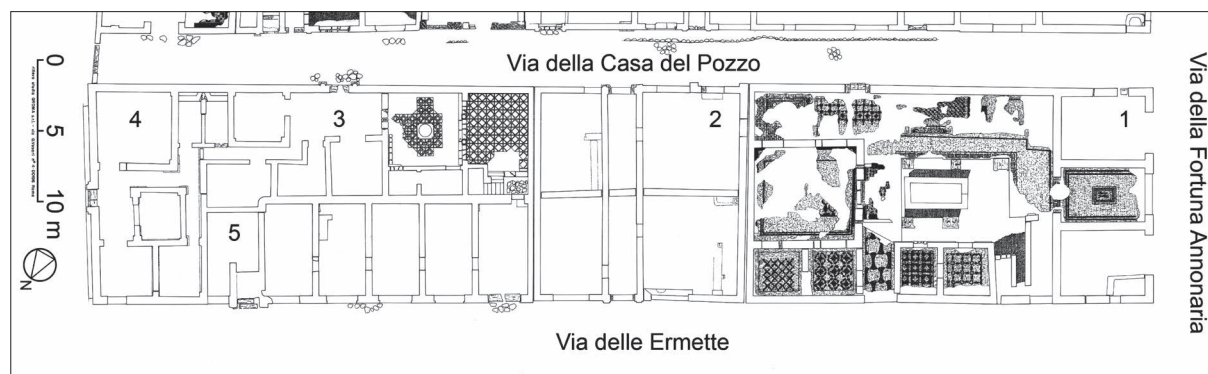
Pianta dell'isolato V, III (riel. SSBAR 8458).
